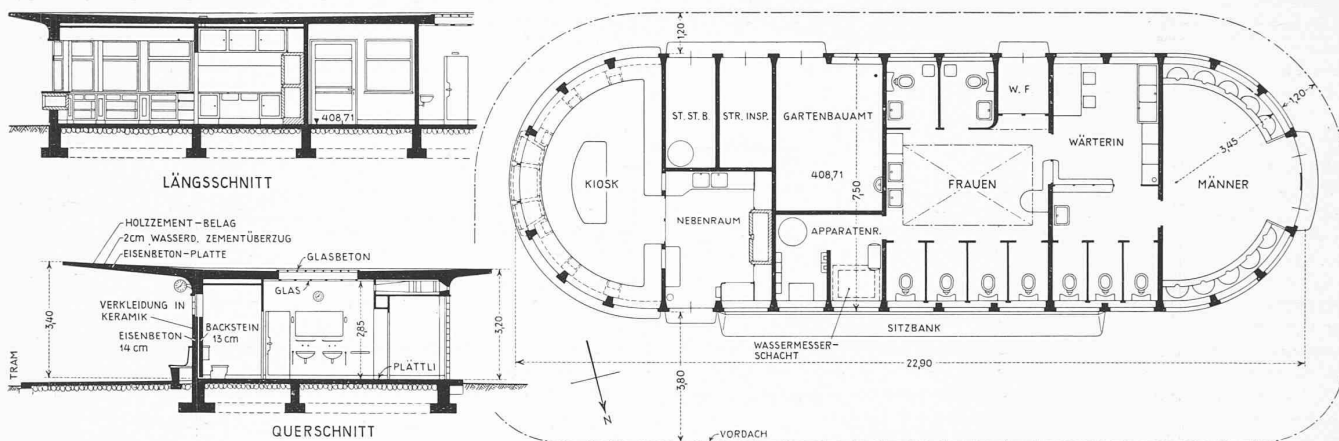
Schnitte und Grundriss des Dienstgebäudes am Bellevueplatz. Arch. Stadtbaumeister H. Herter. — Masstab 1 : 200
